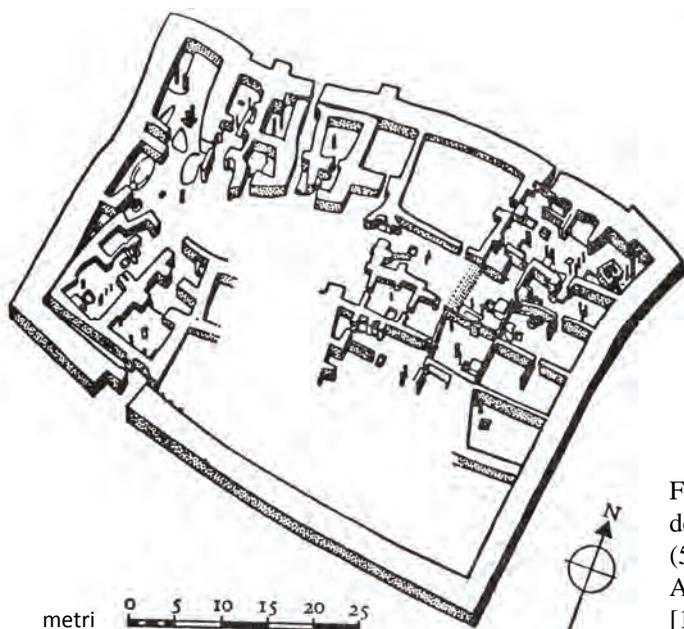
Planimetria della fortezza di Hacilar II (5.317 a.C., Turchia-Anatolia), elaborazione da [10 p. 220].
